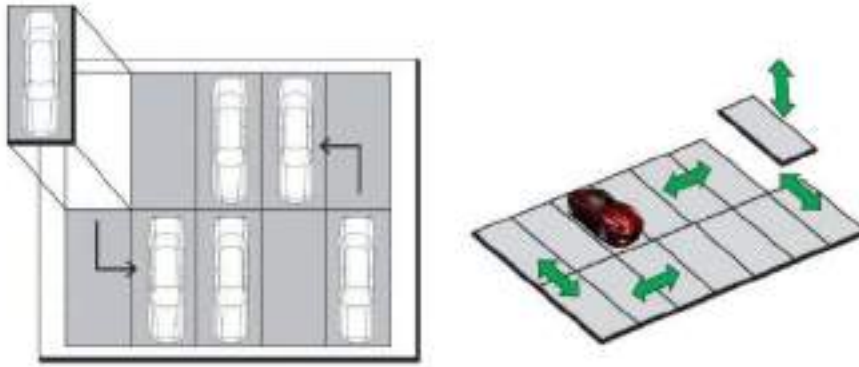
Contoh tipe garis vertikal pada UD Type convey Parking dengan akses langsung
